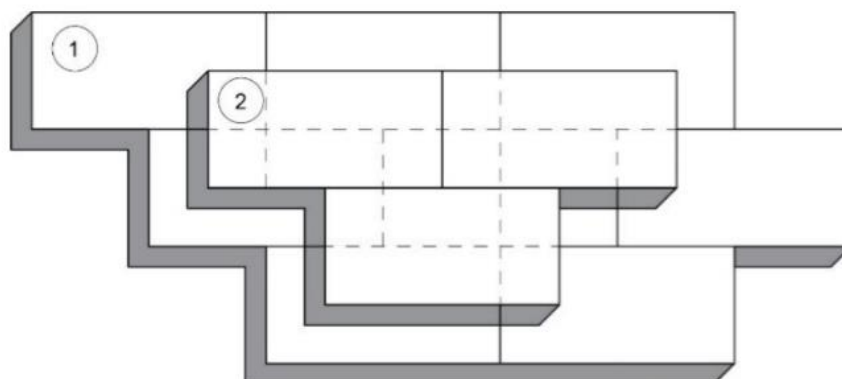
Смещение плит верхнего и нижнего слоев при укладке. 1 – нижний слой плит; 2 – верхний слой плит.
